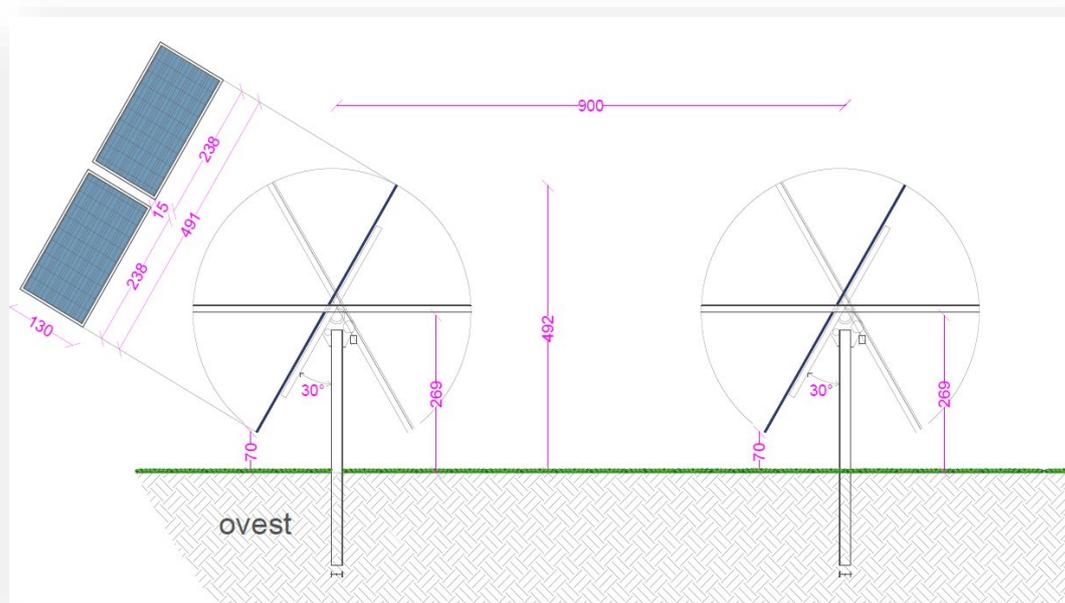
Sezione tipo impianto con installazione su sistema ad inseguimento solare tipo tracker
